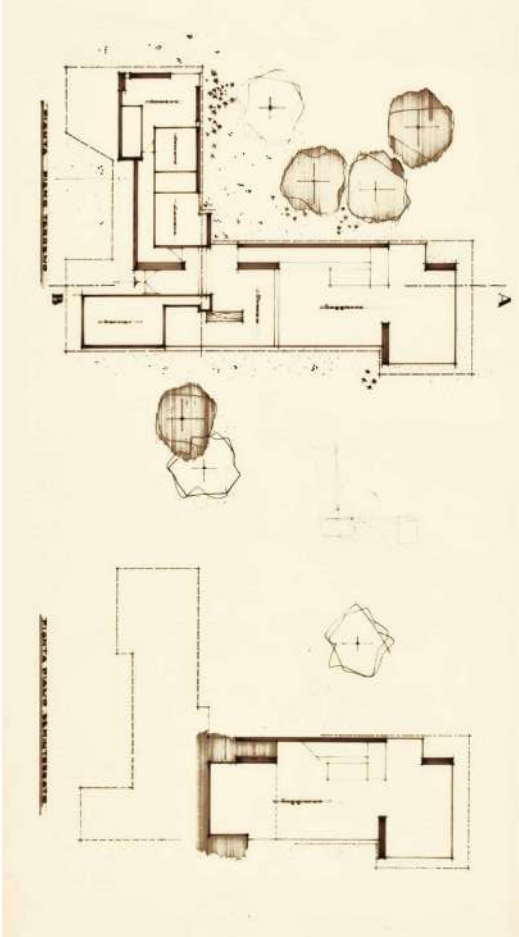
R. Gizdulich, "Villetta tipo n. 1", pianta piano terra e pianta piano seminterrato, s.d.
